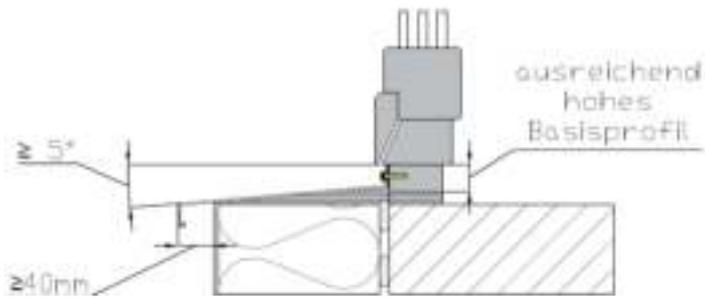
Fensterbankanschluss mit ausreichend hohem Fensterbankanschlussprofil mit mind. 5° Fensterbankneigung und einem Fensterbankvorsprung von mind. 40 mm
